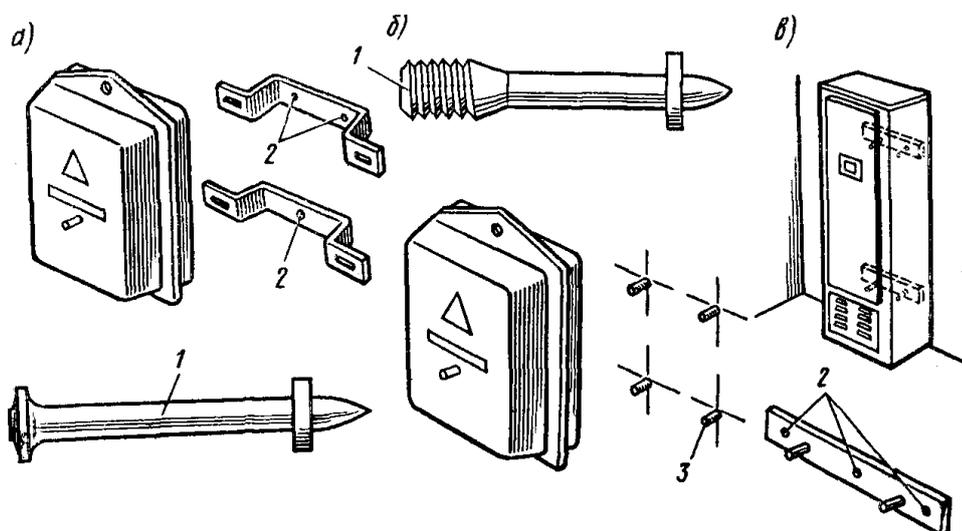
Крепление аппаратов управления; а — несъемное; б — съемное; в — комбинированное крепление шкафов; 1 — дюбель-гвоздь; 2 — место пристрелки детали дюбель-гвоздями; 3 — дюбель-винт
